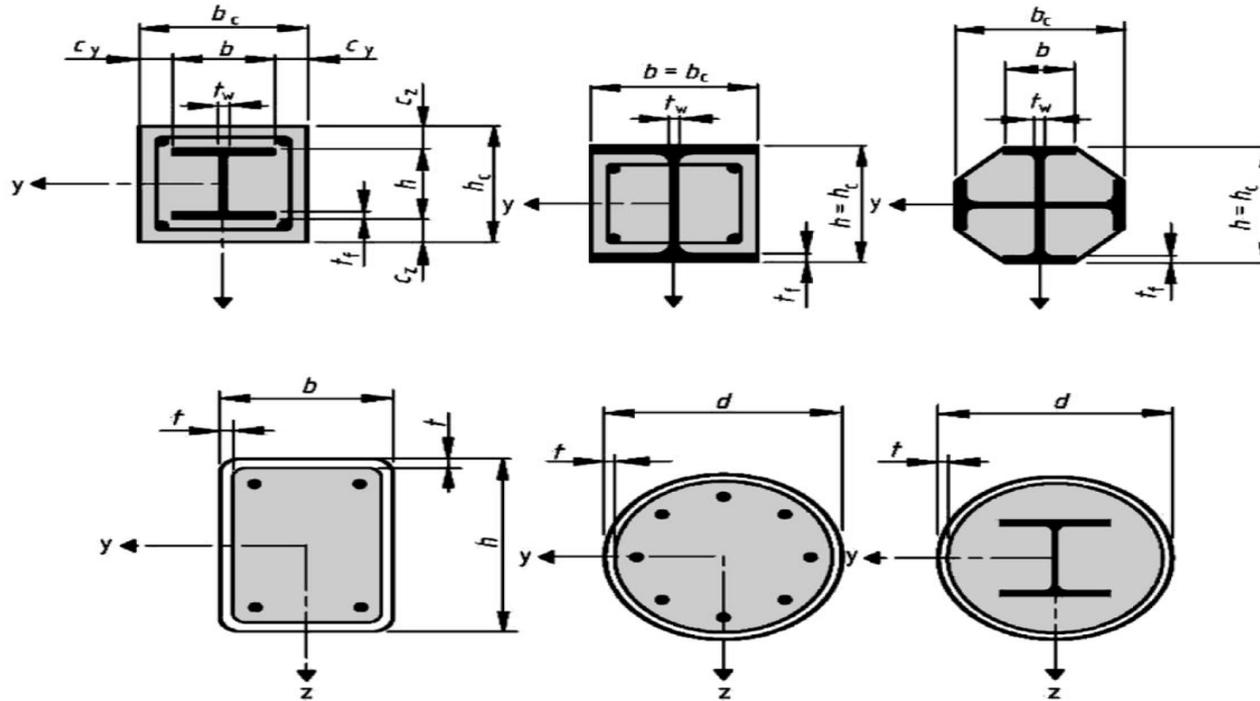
Наиболее распространенные типы сечений сталежелезобетонных колонн
